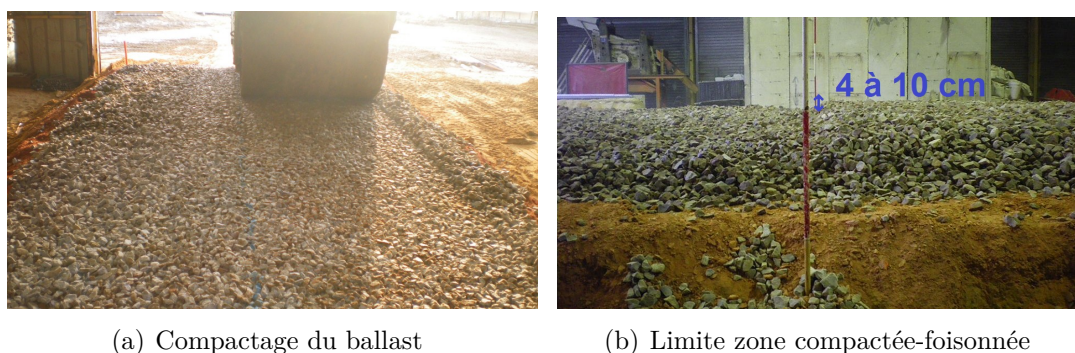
Photographie du compactage de la planche 2 avec 30 cm de ballast
